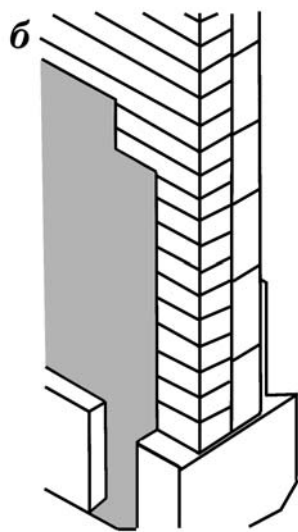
Конструктивная схема выполнения гидроизоляции: б – общий вид фрагмента каменной стены основания дома с гидроизоляцией (окрасочная и клеенчатая)
